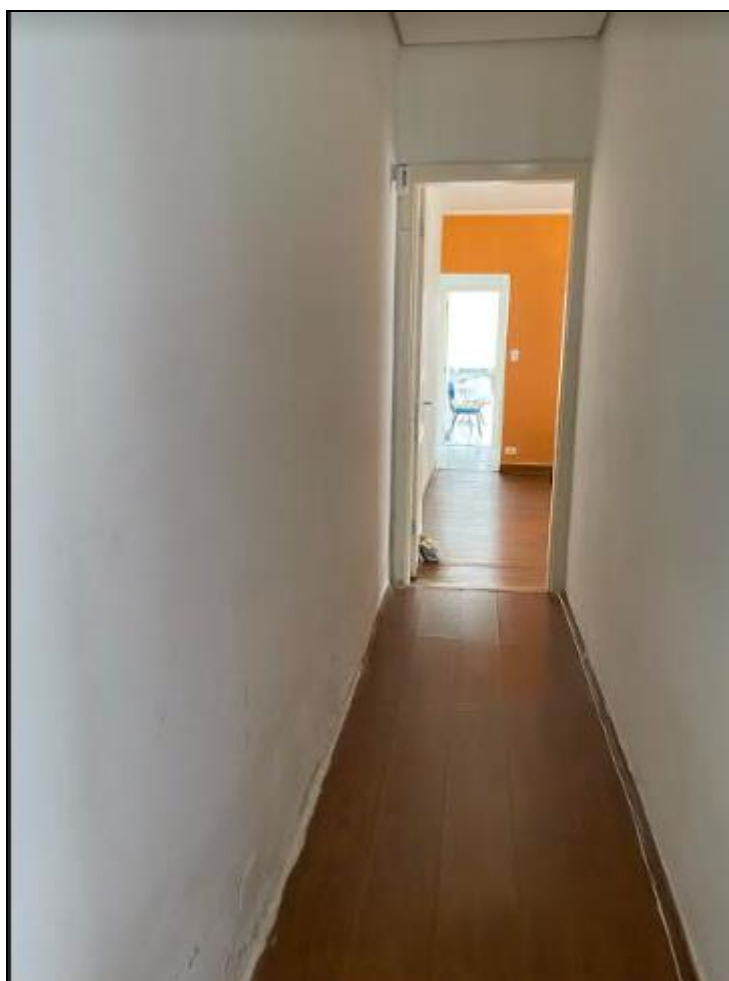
MANCHAS PAREDES DIVISA GEMINADA.
